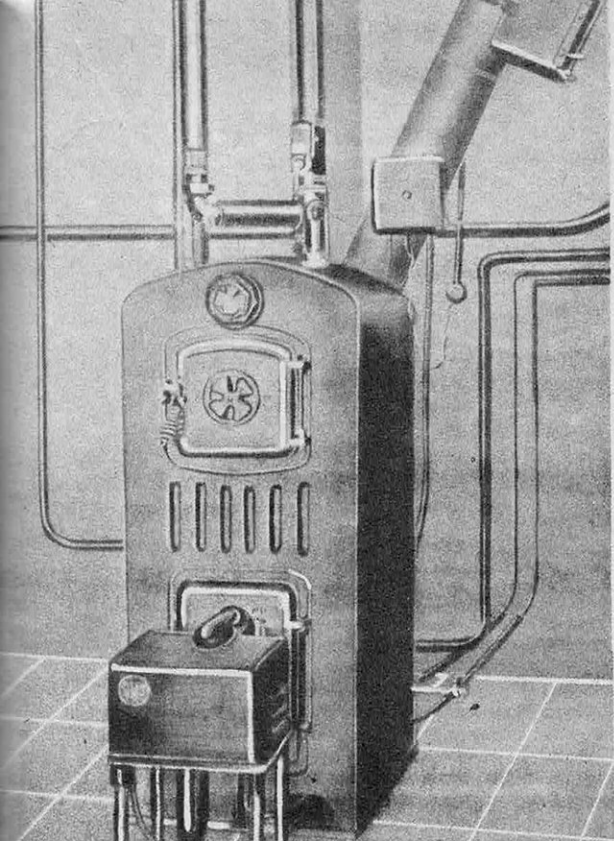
PETITE INSTALLATION DE CHAUFFAGE CENTRAL AU MAZOUT D'UN PAVILLON
